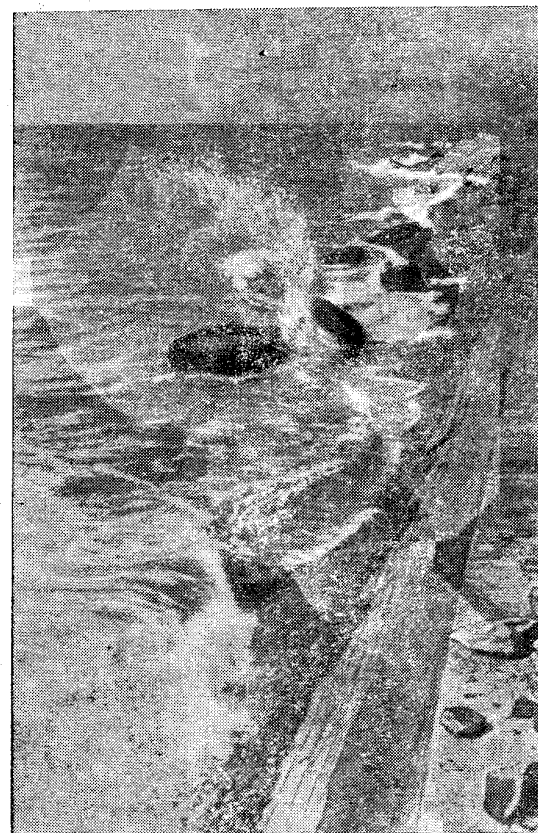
Массивная бетонная волноотбойная стенка с плоской наклонной наружной гранью.
